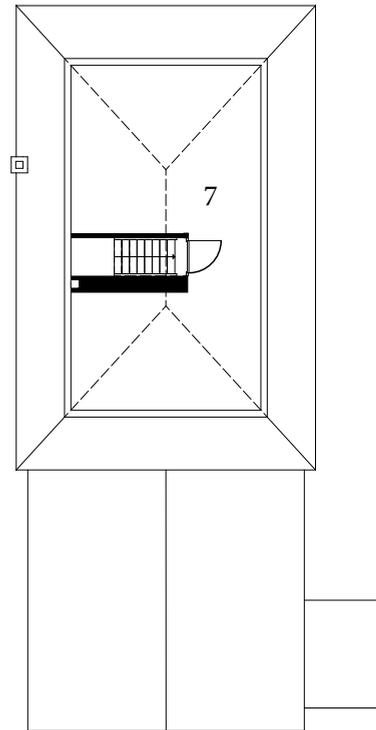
Grundriss Dachgeschoss 2. Bauphase 1:200
